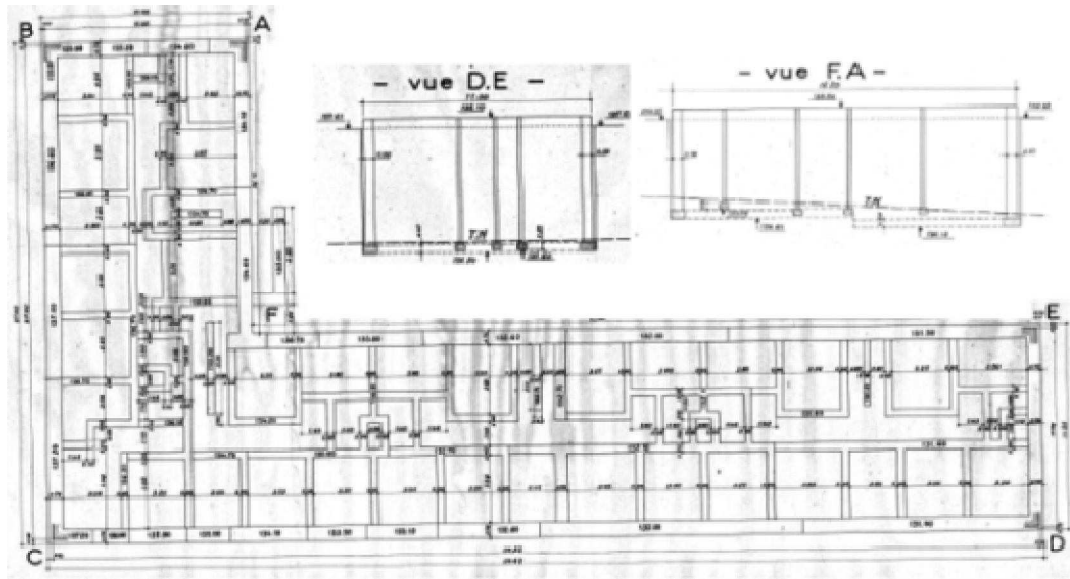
14: Vue en plan et en coupe des fondations bâtiment E [19].
